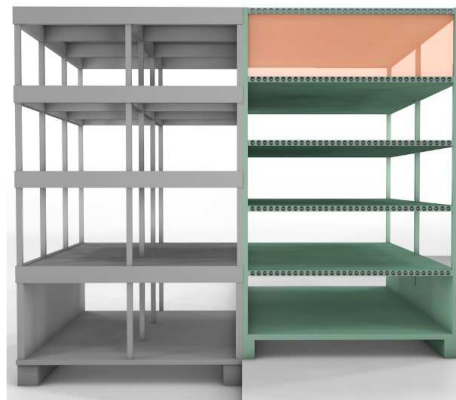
Конструкция здания с различными плитами перекрытий
